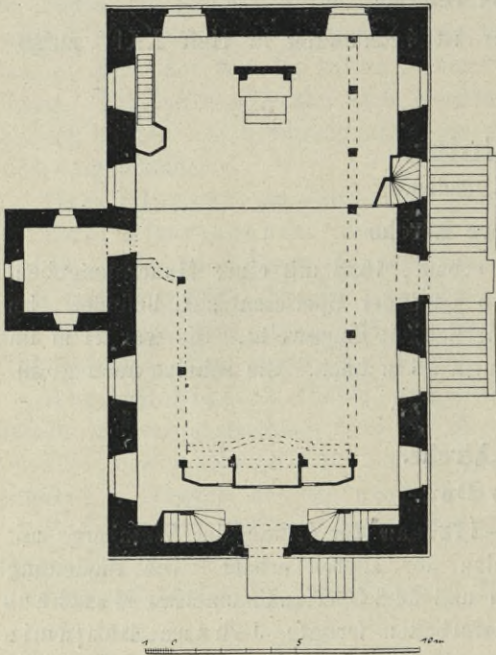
Pillnitz, Bergkirche, Grundriss.
